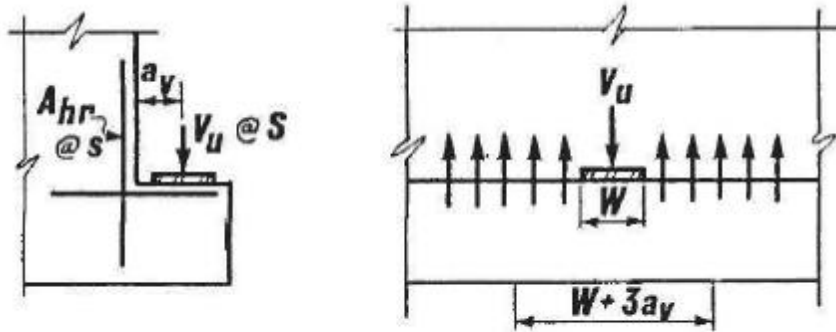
Refuerzo para Viga Repisa simple
